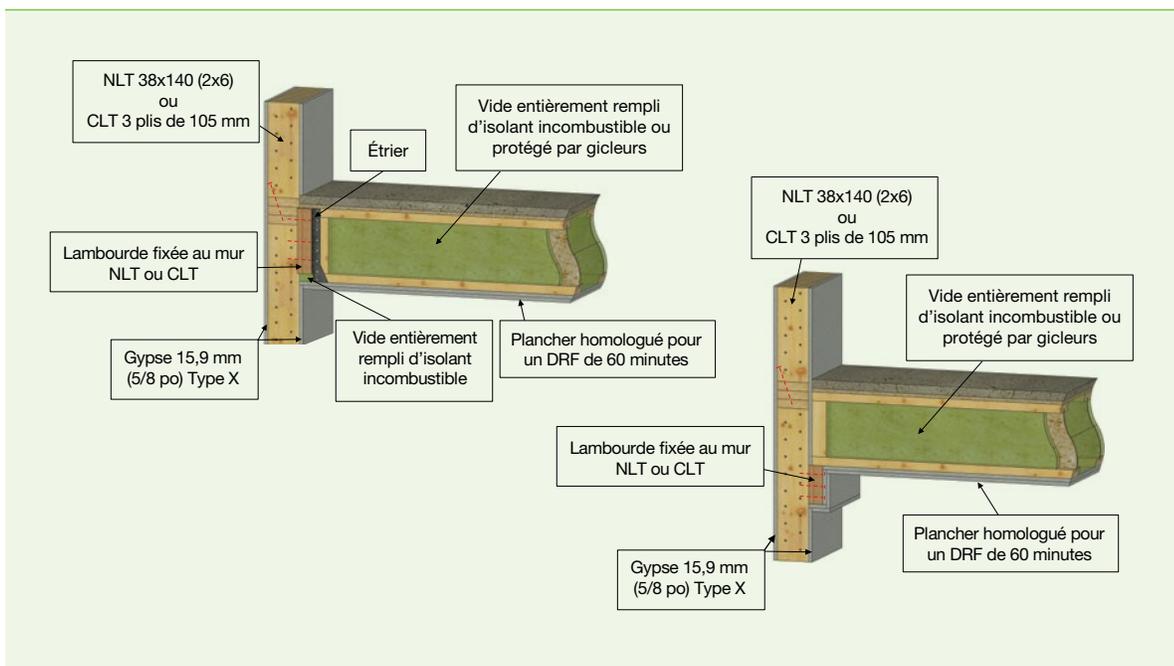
• Détail de jonction mur/poutrelles de plancher parallèles au mur
